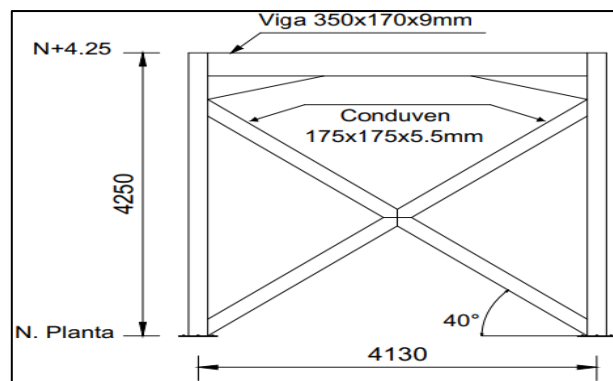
Pórtico entre N. planta y N+4.25, con arriostamiento lateral en "X", viga 350x170x9mm, y luz de 4.13m
